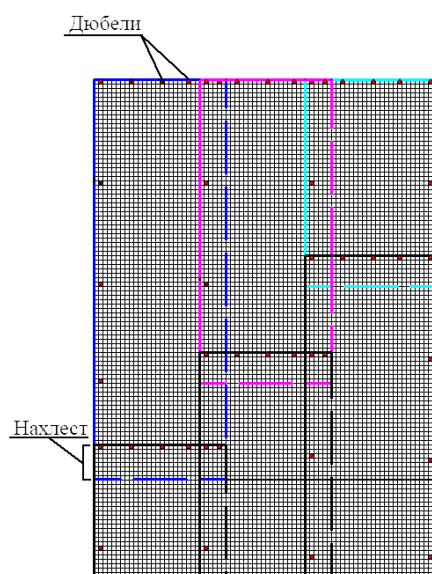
Схема расположения полотен геосеток при сплошном армировании.
